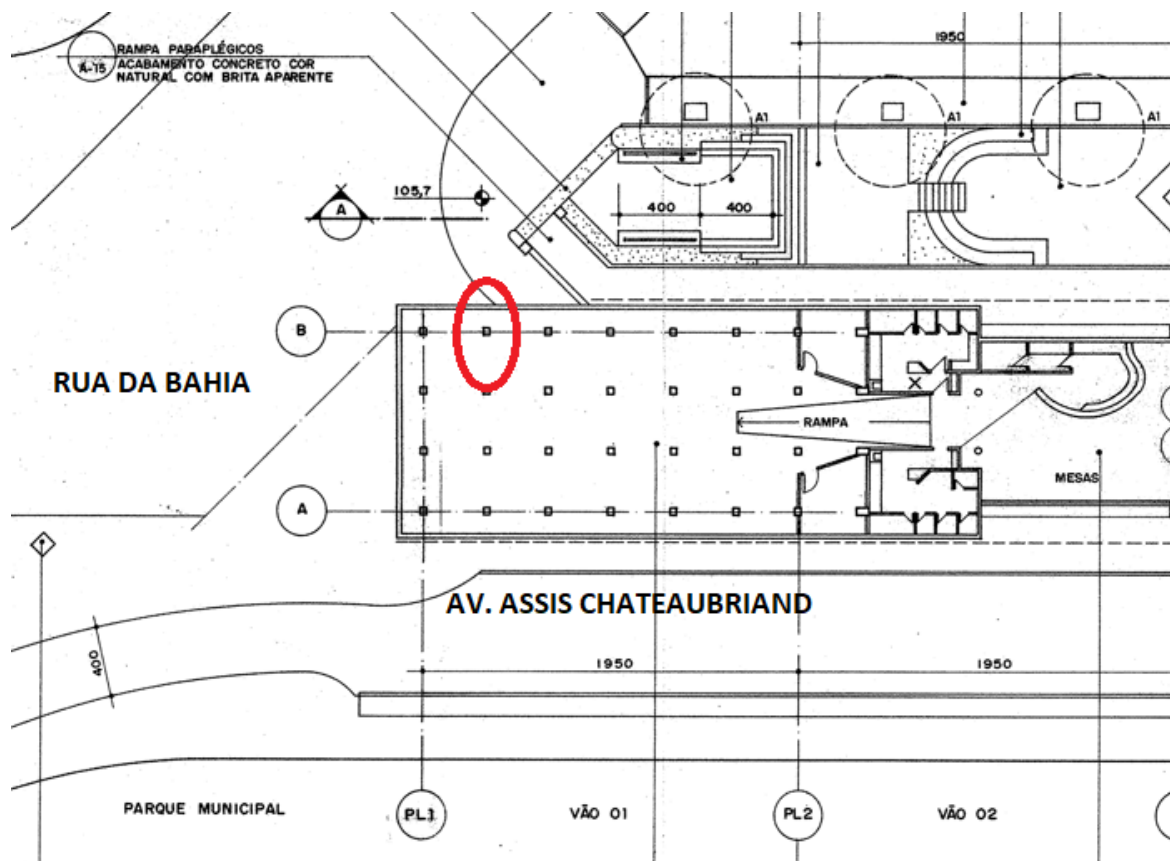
Planta de localização da patologia da figura 3, acesso em planta arquitetônica do viaduto Santa Tereza cedida pela Prefeitura de Belo Horizonte.
